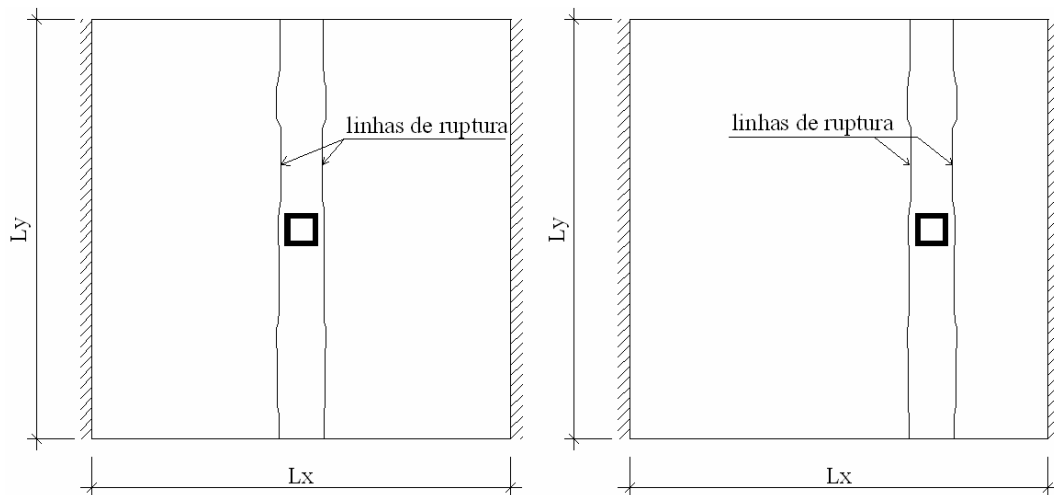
Configuração adotada para as linhas de ruptura das lajes
